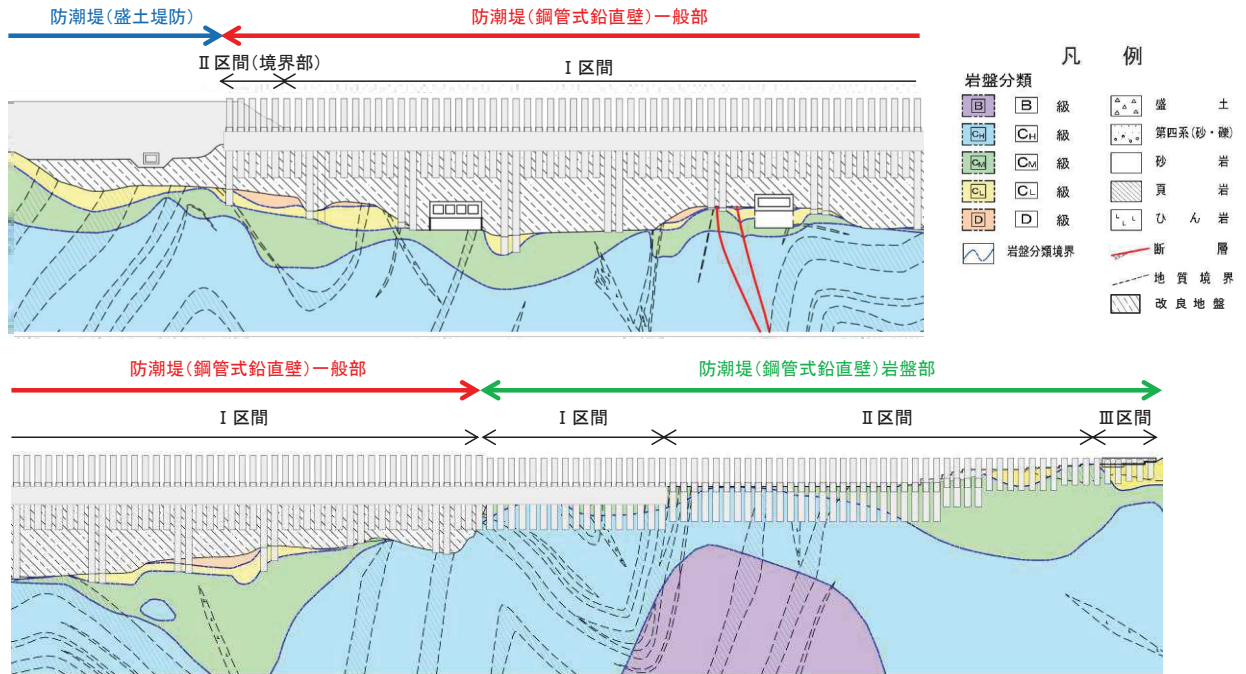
防潮堤（鋼管式鉛直壁）の平面配置図
